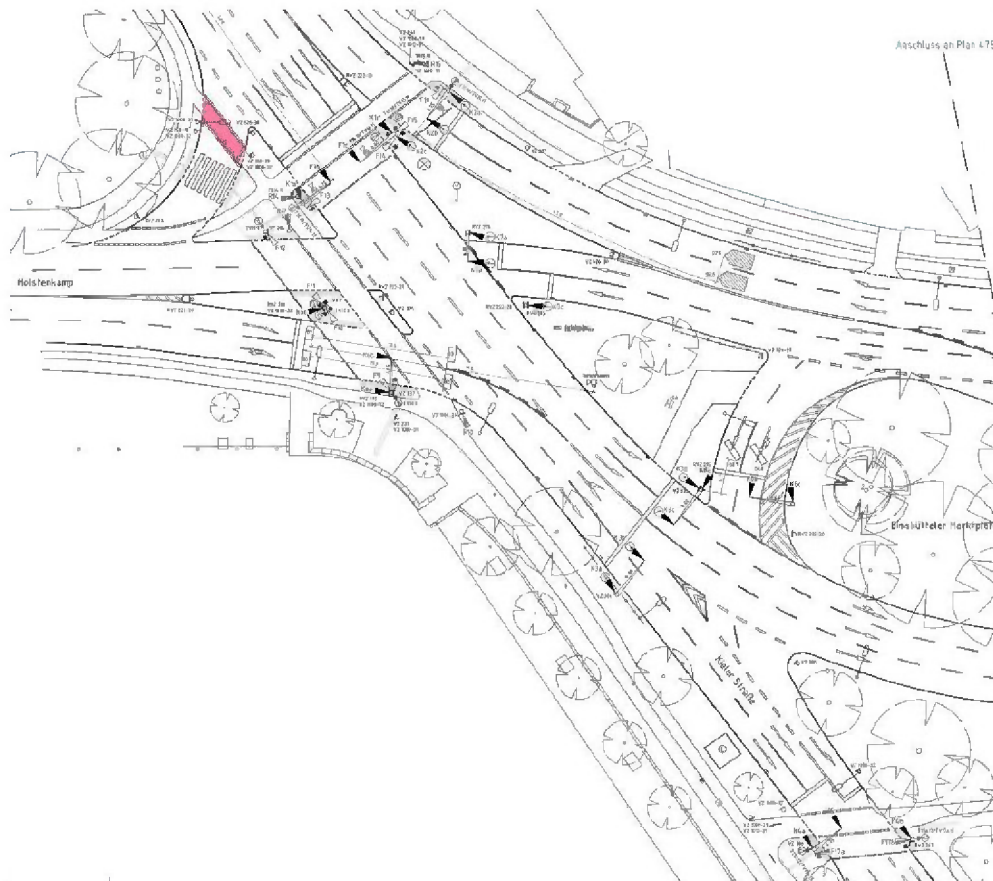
Signallageplan Teilknoten Kieler Straße/Holstenkamp – Bestand (15/1601-04-06/03)
